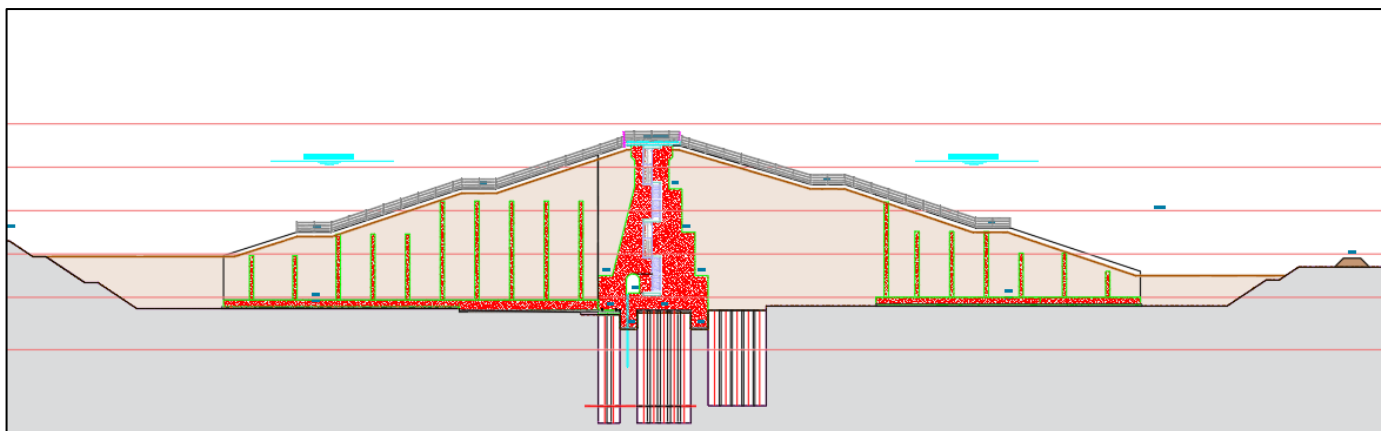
Sezione trasversale in corrispondenza dei muri di contenimento dei rilevati arginali all'estremità ovest dei manufatti
